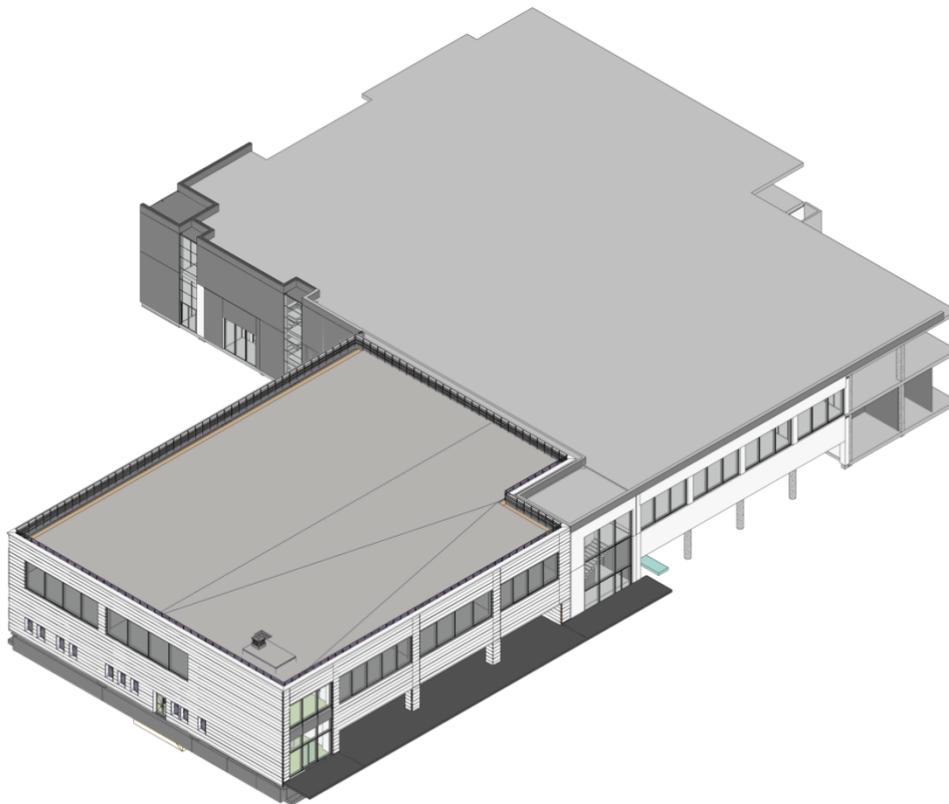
Vista 3D del modello, prospetto air side/prospetto sud ovest
